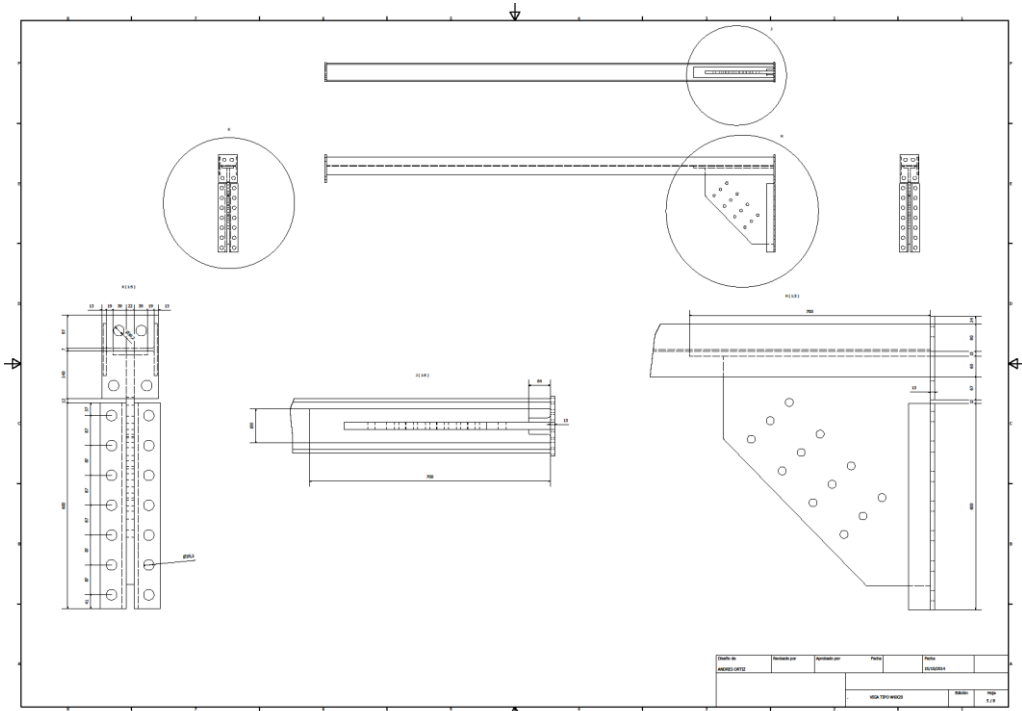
Planos de taller Vigas Tipo2 para Refuerzo Estructural Col. San Pedro.
